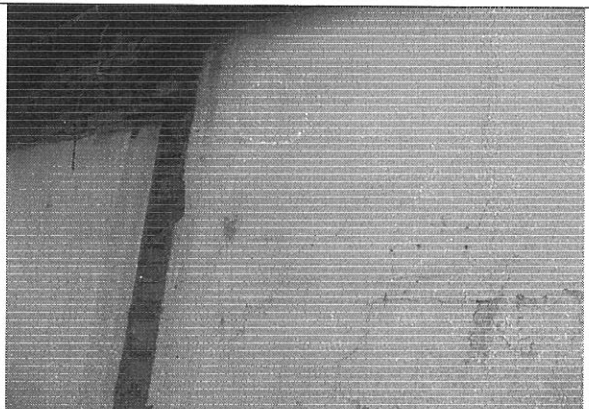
Desprendimientos de unidades de mampostería en muro de la construcción interna
